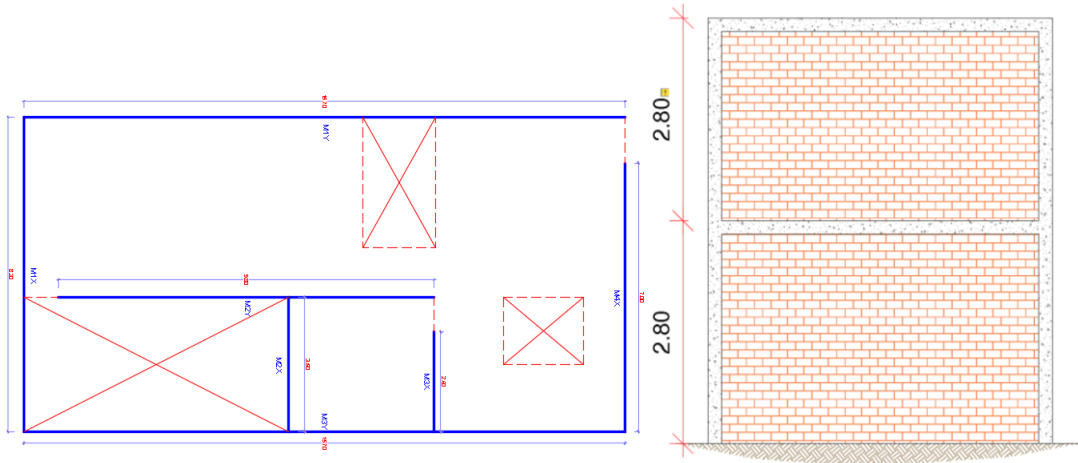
Levantamiento de la edificación analizada 45, plano utilizado para el estudio CH-70
